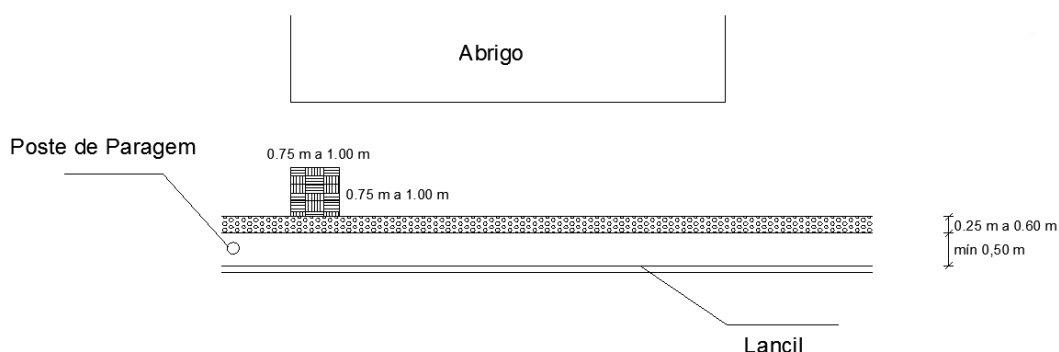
Pormenor do pavimento tátil do abrigo
